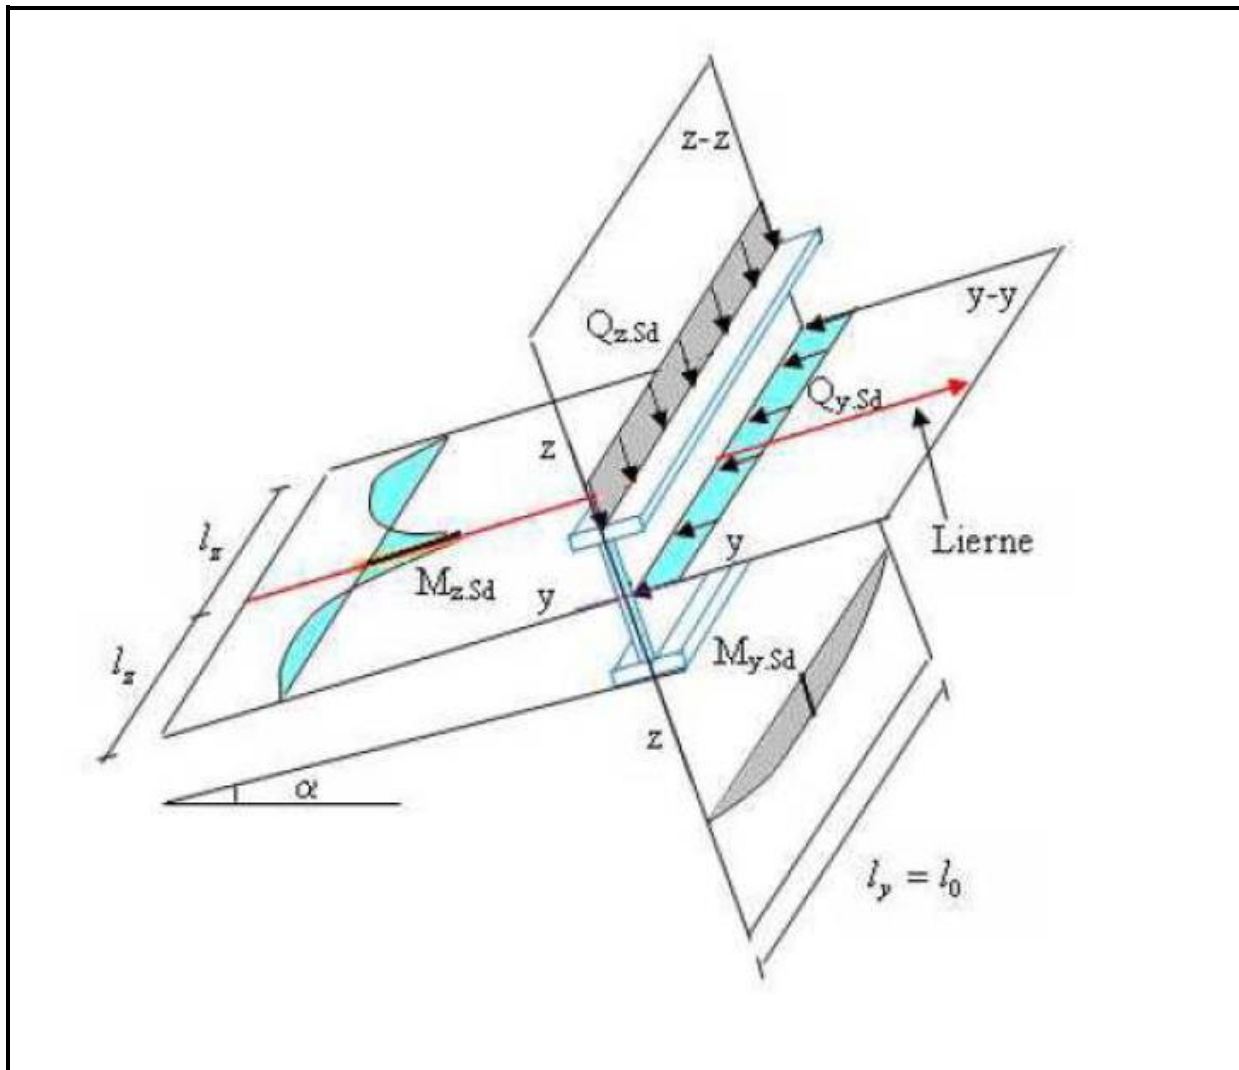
Panne de toiture en flexion sous les différents plans de chargement.
